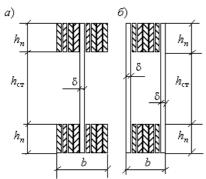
Поперечные сечения клееных балок с плоской фанерной стенкой
